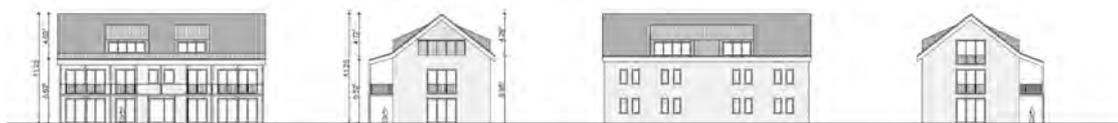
, Fassaden Baubereiche B und C, 2-geschossig
